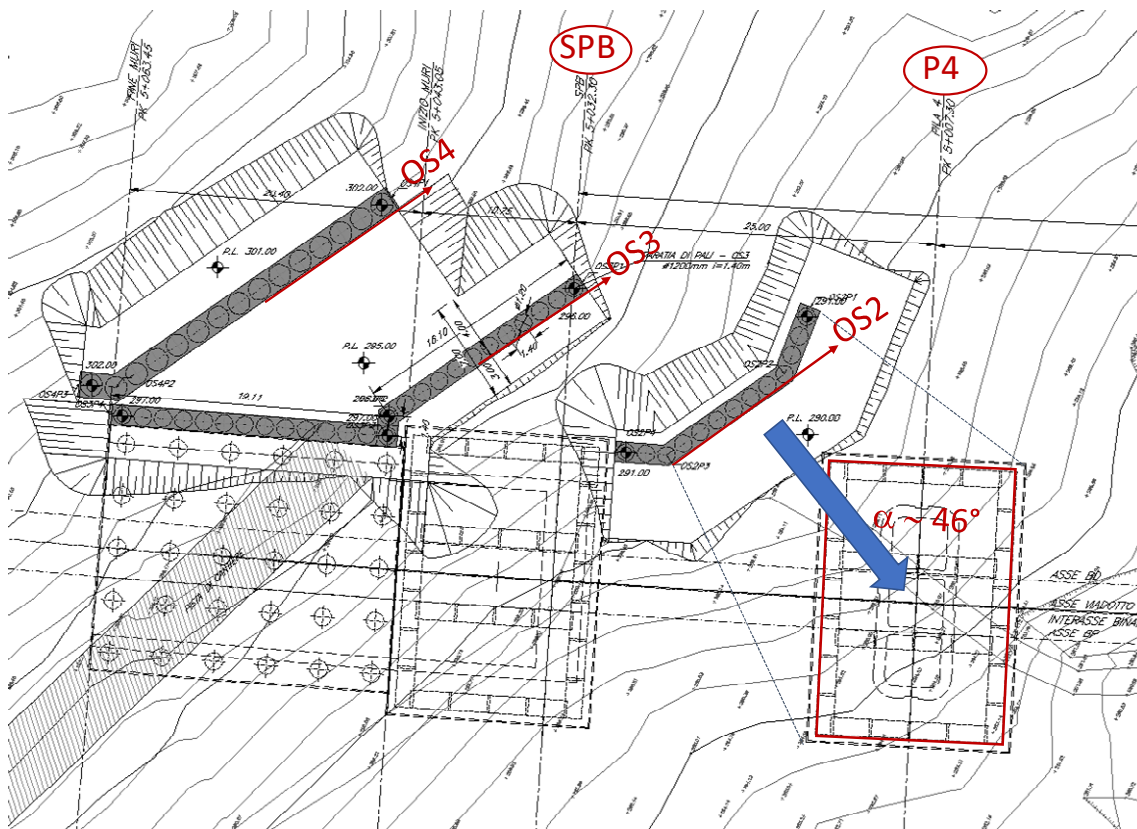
Viadotto VI02. Pila 4 e Spalla B: inquadramento opere di sostegno e stabilizzazione OS1-OS4
